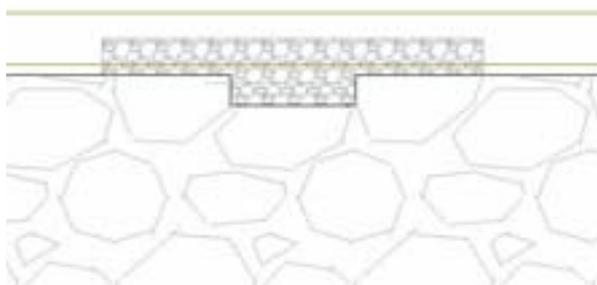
Detalle de alzado del Hormigonado de la solera del pozo.
